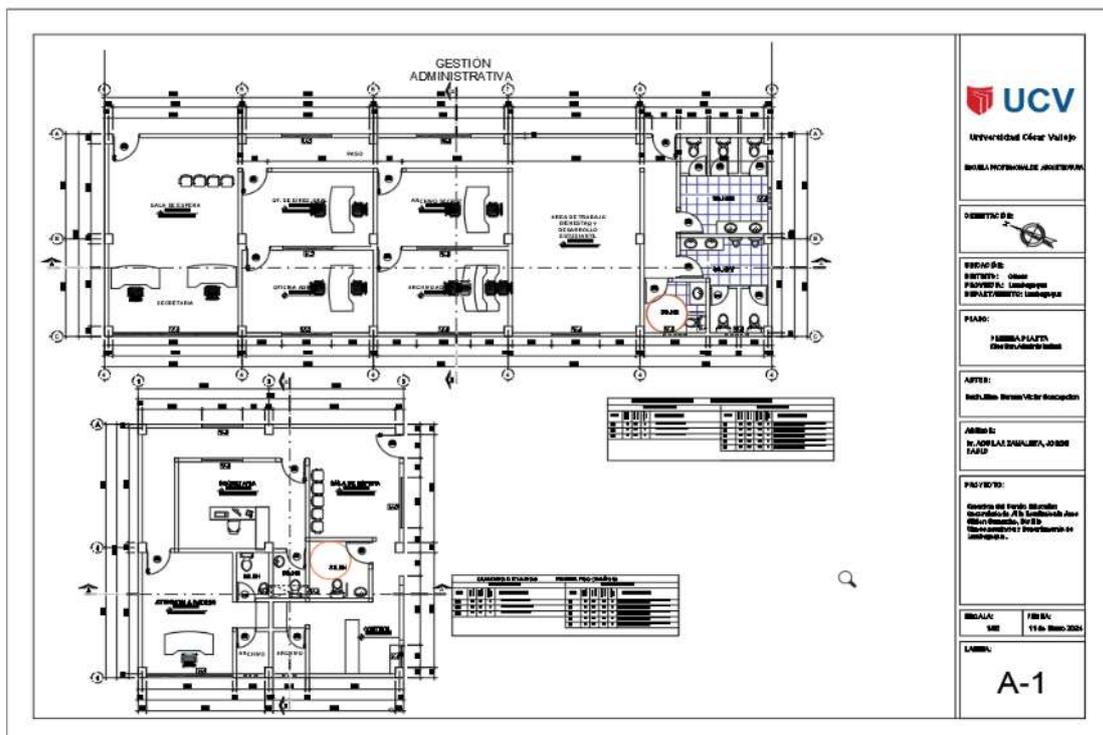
Planos De Distribución Por Sectores Y Niveles - Planta General Gestión Administrativa
